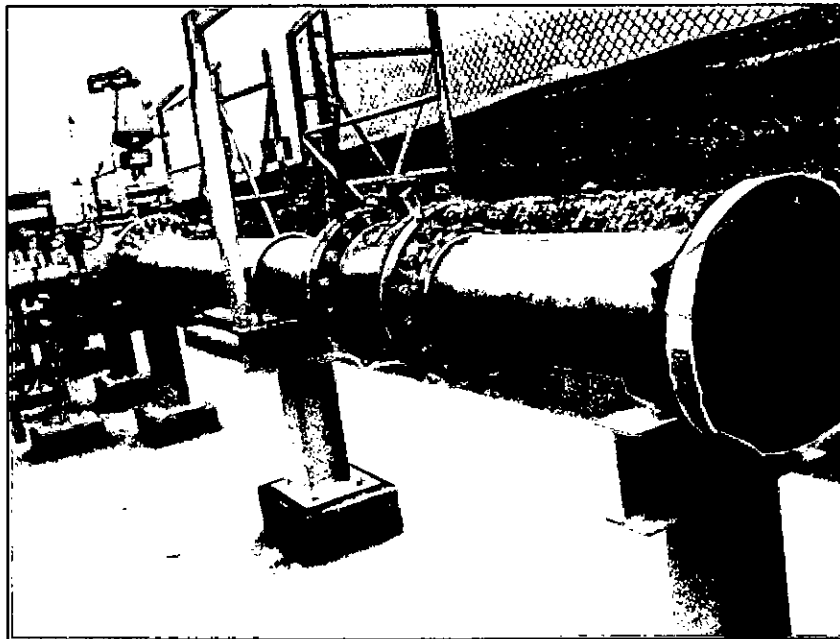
Instalación de soportes para tuberías- Fuente propia
